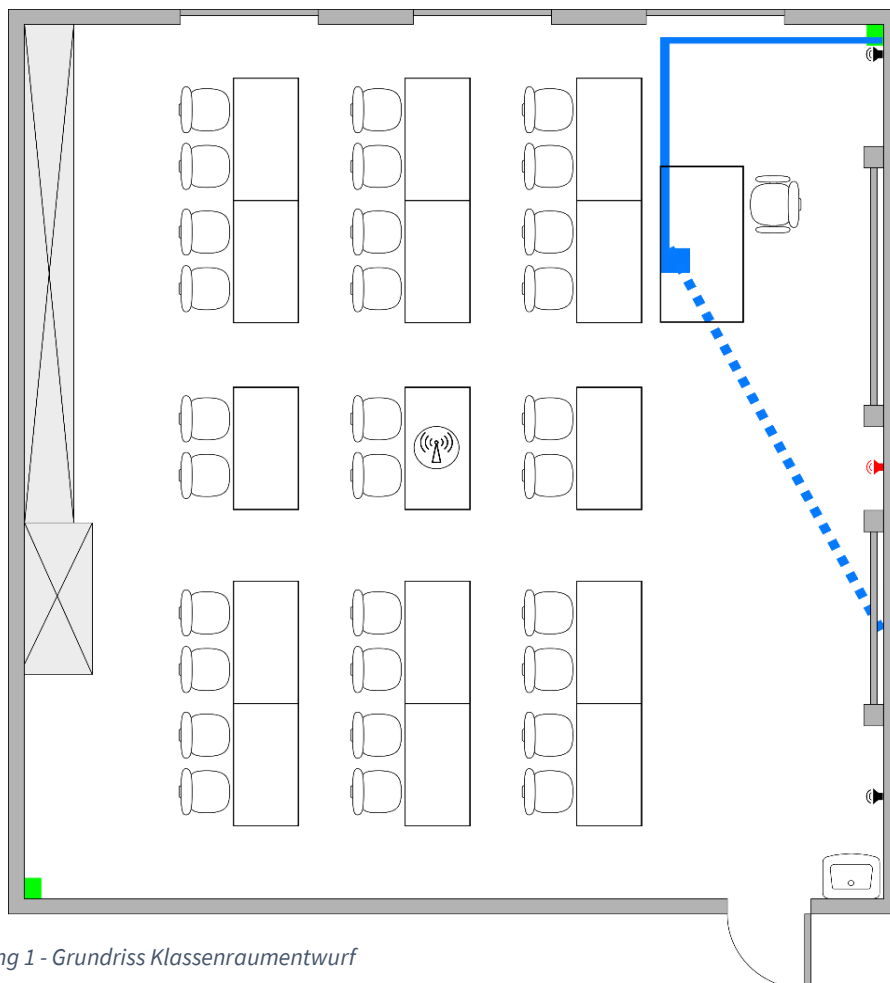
Grundriss Klassenraumentwurf
